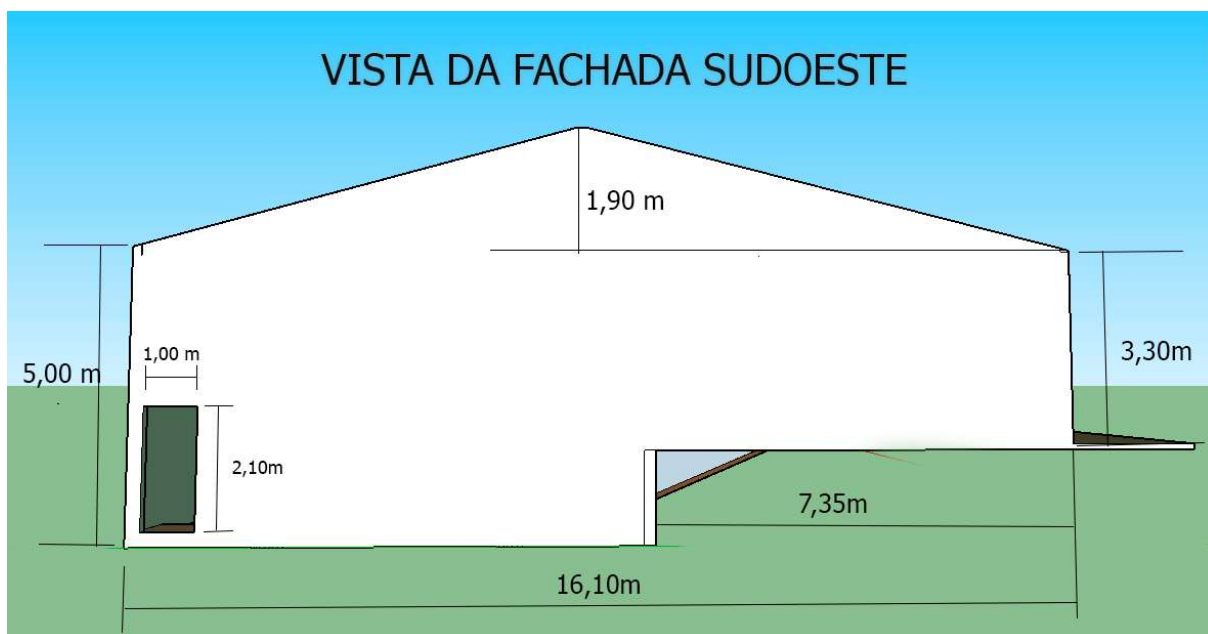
Características dimensionais da fachada sudoeste do salão.
